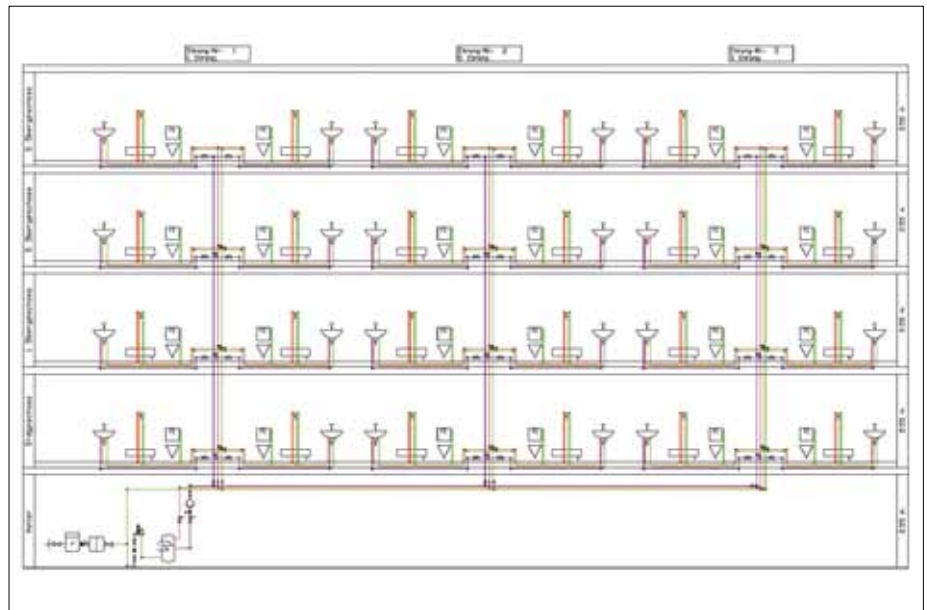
Vergleichsgebäude mit durchgeschleifter Kalt- und Warmwasserleitung und eingeschleifter Zirkulation auf Stockwerksebene.
